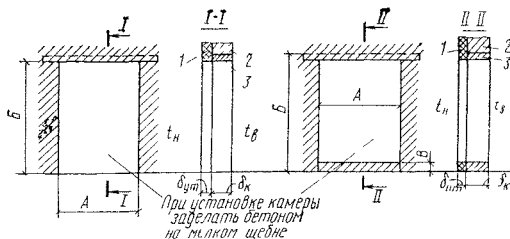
Проемы в стене узла воздухозабора для установки камер
